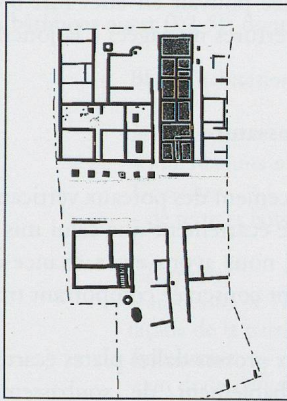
Parcelle B, bâtiment ouest (locaux 2-14) (état 8). Type : enfilade de pièces. Plan et élévations schématiques. Pour les conventions graphiques, se reporter à la fig. 217. Pour des raisons de lisibilité du dessin, seul un poteau vertical sur deux a été figuré ; les entre-axes sur le schéma font donc un mètre en moyenne, alors qu'ils devaient être de 50 cm dans la réalité.
